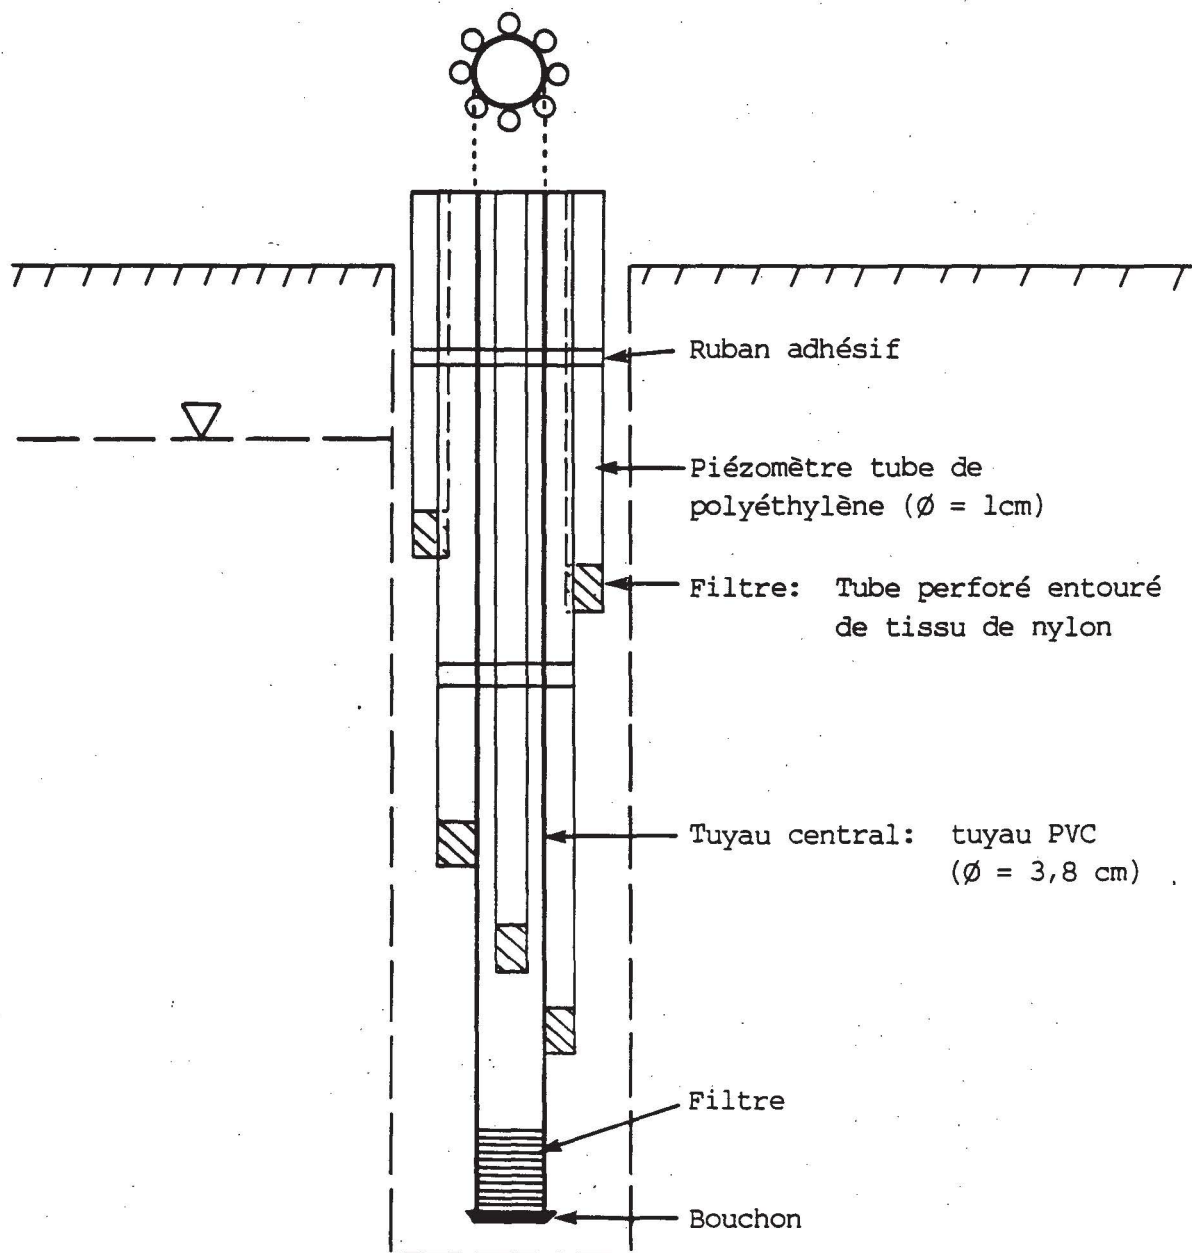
Coupe schématique d'un faisceau de piézomètres
